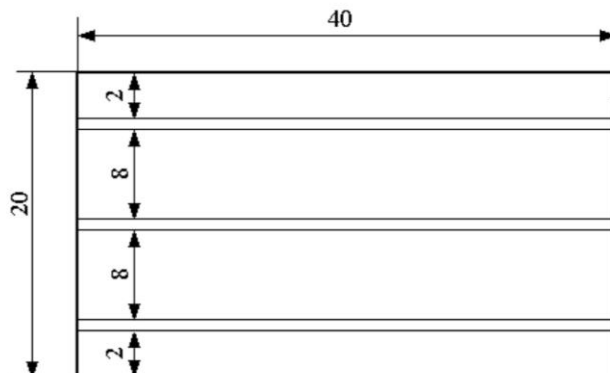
Размещение светильников в цехе, принятое по расчетам примера 5.2
